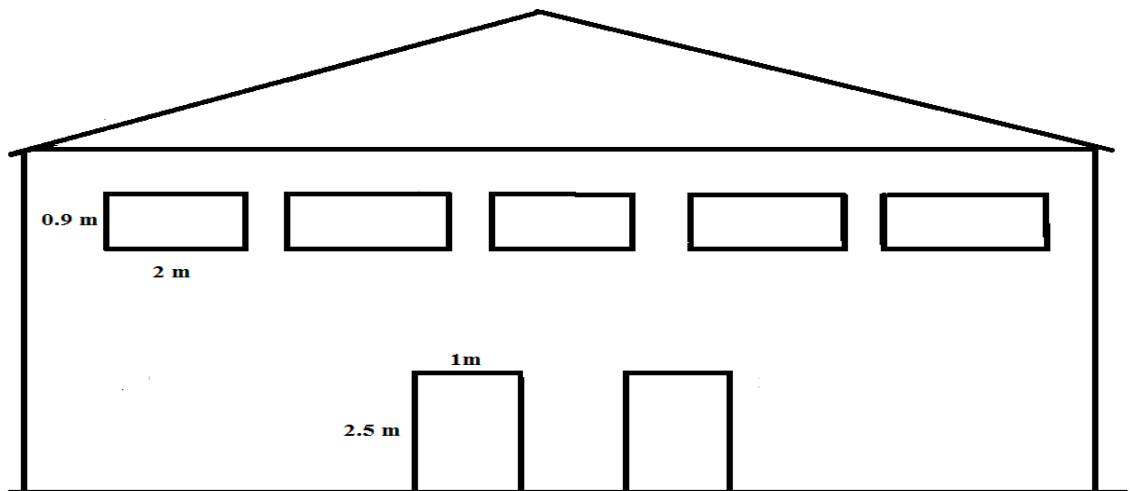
Surfaces des ouvertures sur la façade secondaire.
